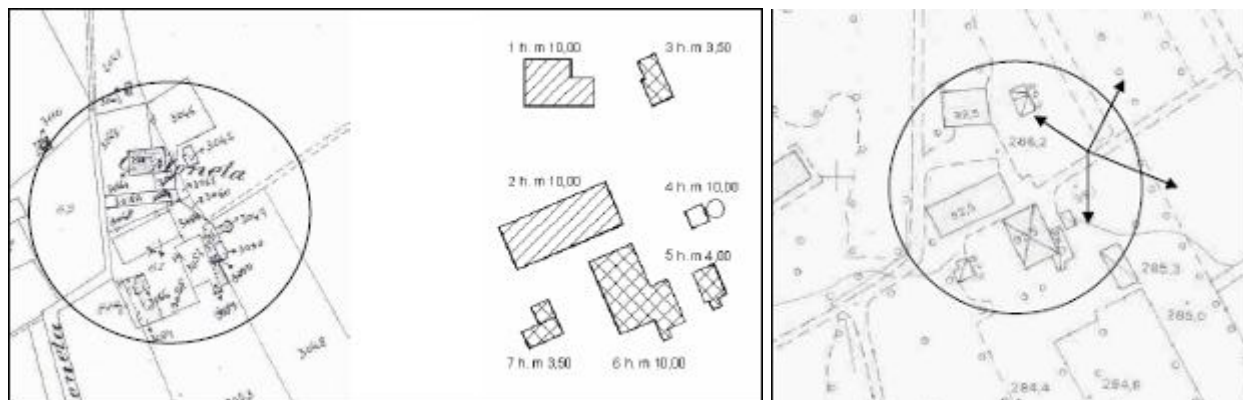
Estratto Catastale scala 1:2000, planimetria scheda, estratto aerofotogrammetrico.
